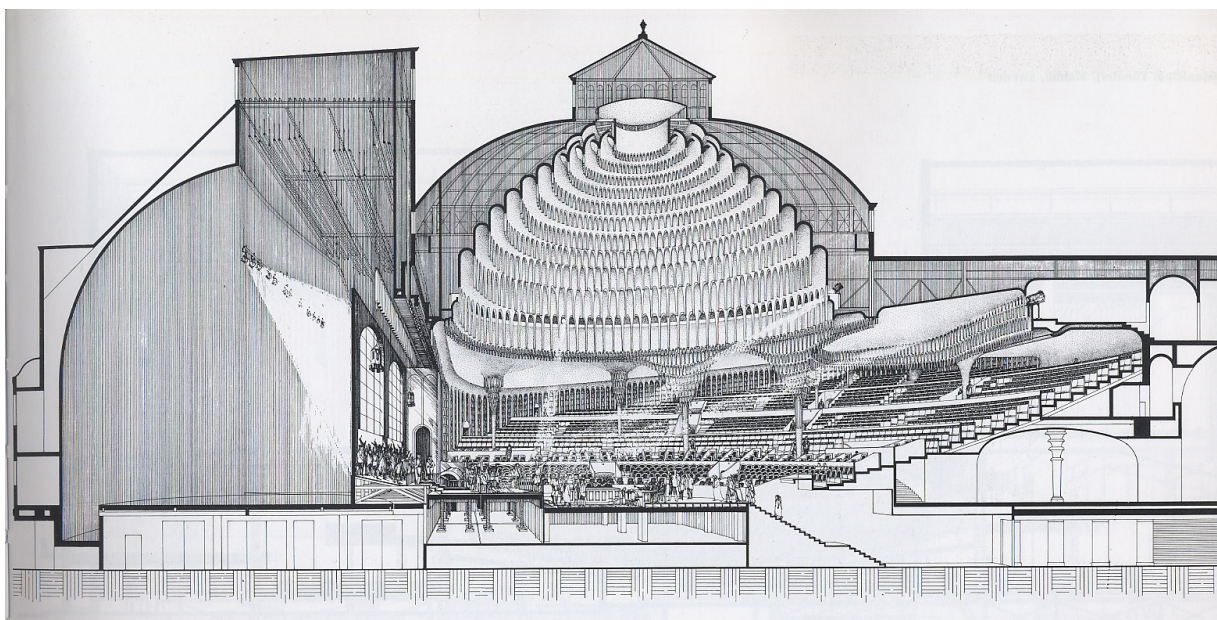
Sezione longitudinale B-B' della Grosses Schauspielhaus, disposizione con palcoscenico avanzato.
